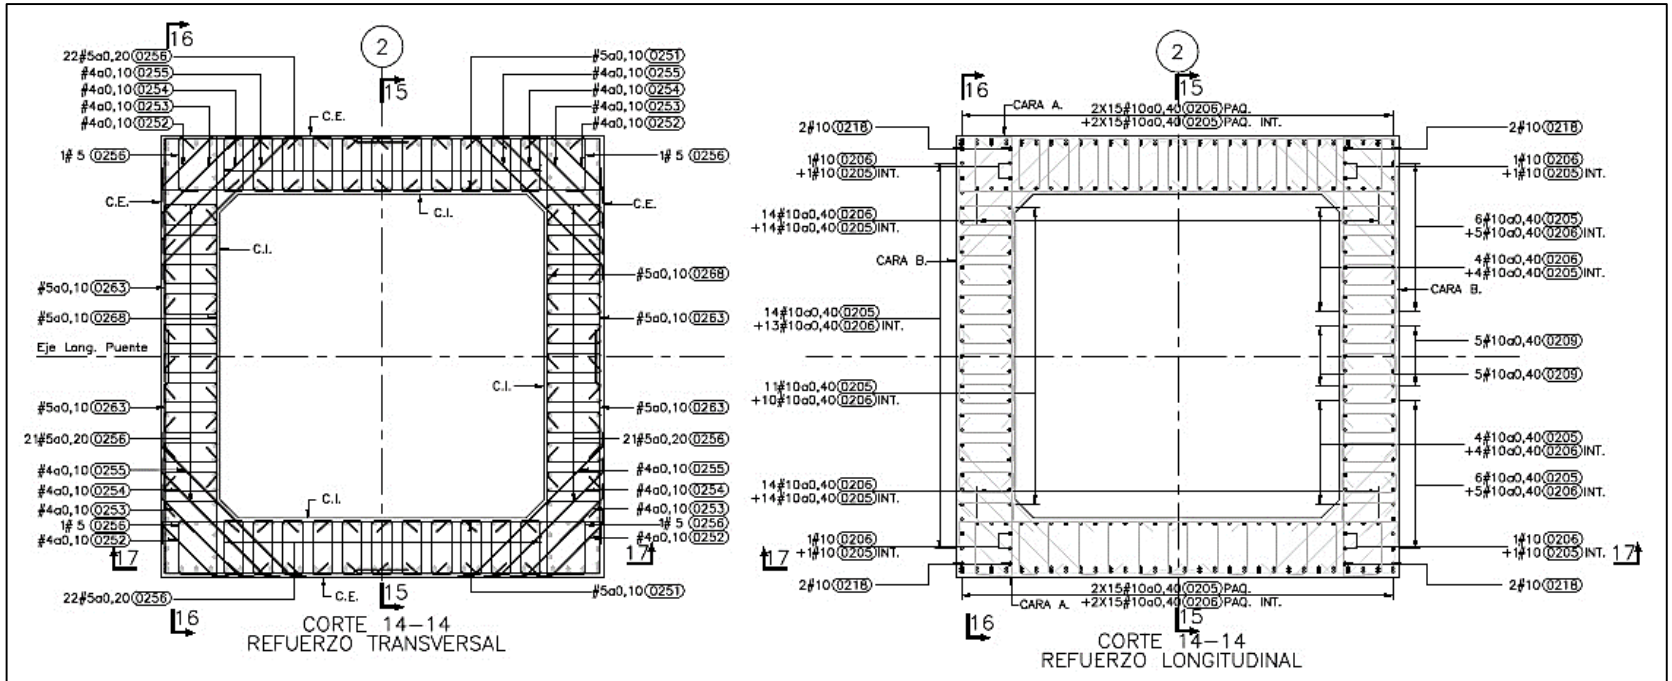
Sección Transversal Superior para pilas con refuerzo longitudinal y transversal.
